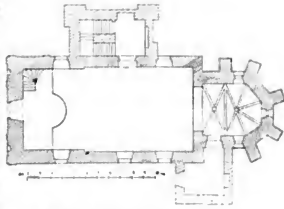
Kadlin. Grundriss der Kirche.
